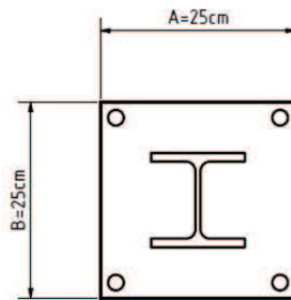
A Dimensions de la placa d'ancoratge
